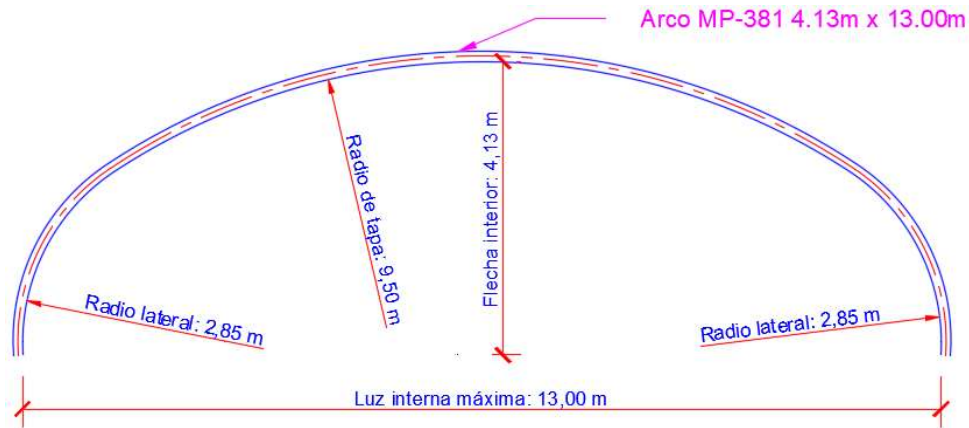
Sección de arco metálico propuesta 13.00mx 4.13m. Fuente: Plano P1 , elaboración propia
